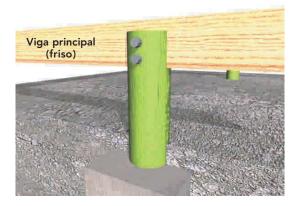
50: Fijación de la viga principal a los pilotes mediante pernos, golillas y tuercas
